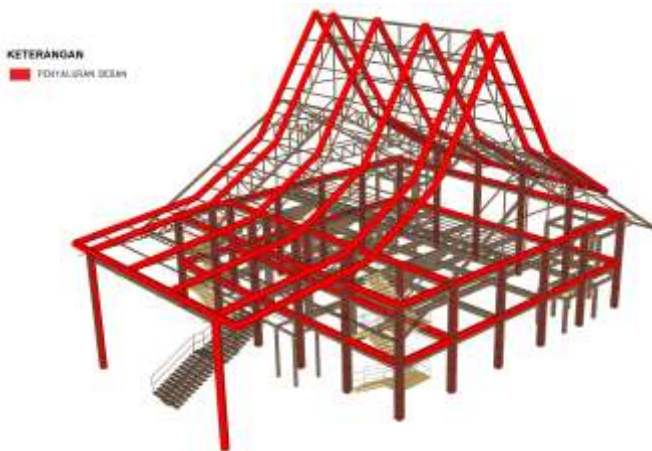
Aksonometri Struktur Massa Utama(Gereja)
